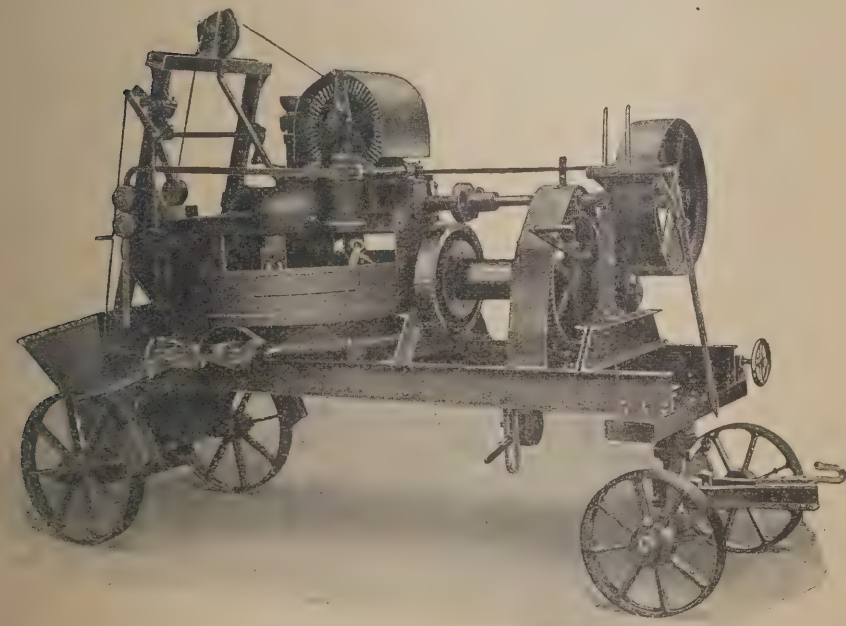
Fahrbare Betonmischmaschine mit Bauwinde.
